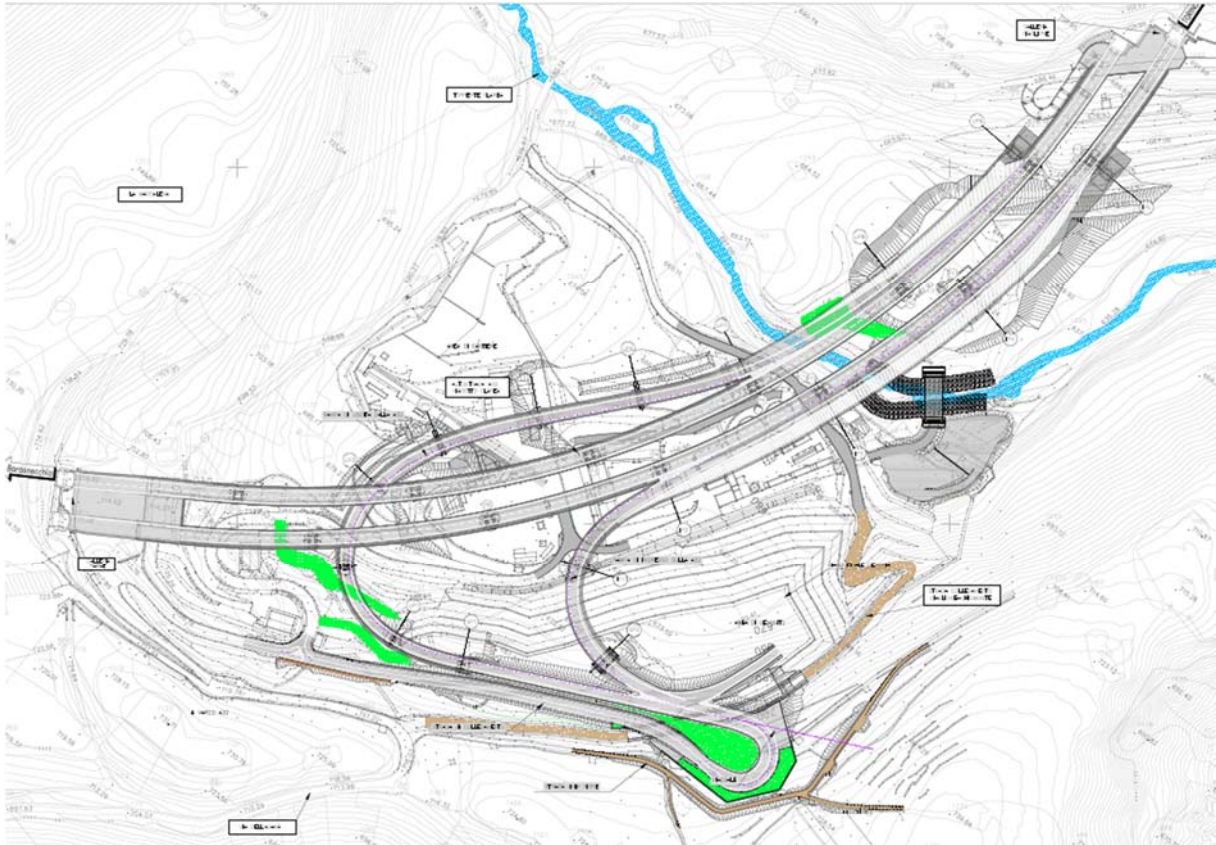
Stralcio planimetrico dello Svincolo della Maddalena
